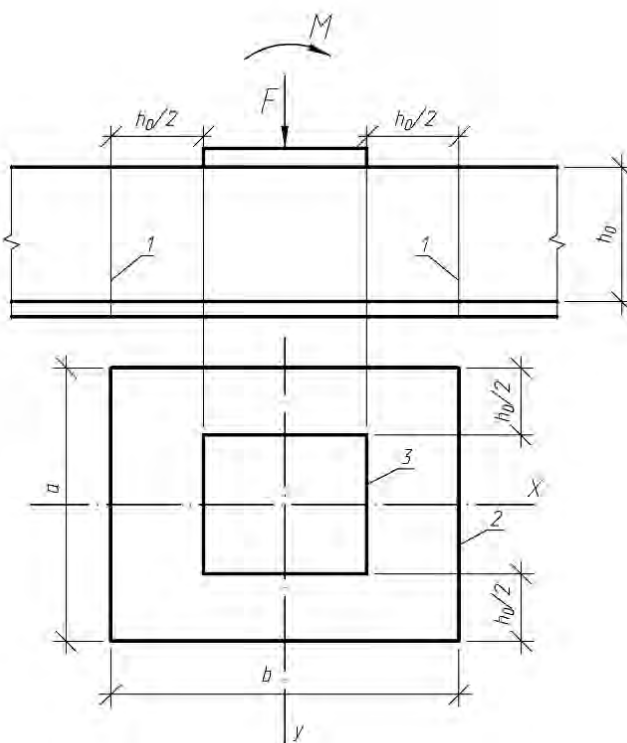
Схема расчета железобетонных элементов без поперечной арматуры на продавливание по [10]:
